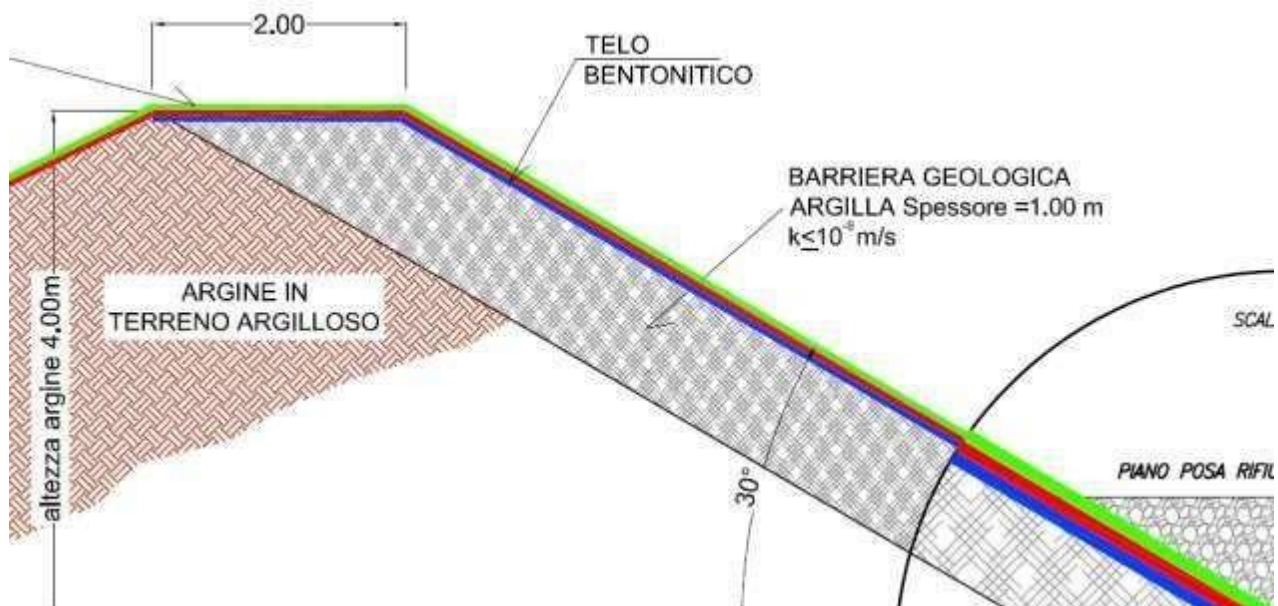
Particolare del pacchetto di impermeabilizzazione del fondo discarica- Estratto della Tavola 14
